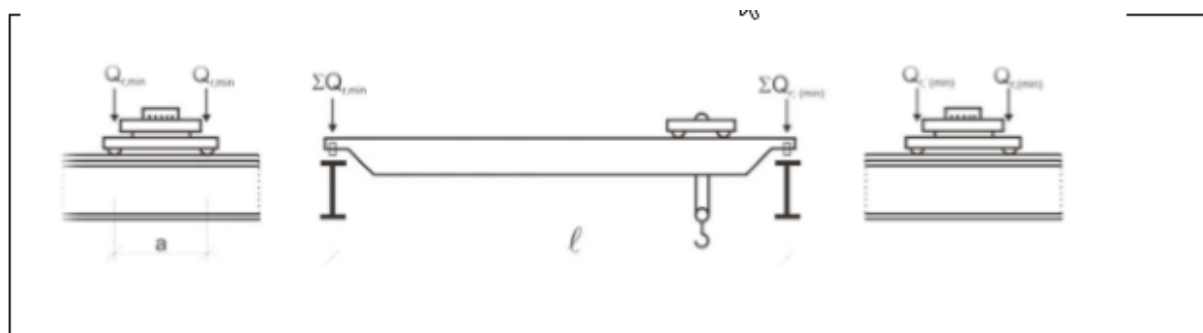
Disposition de charge de l'appareil de levage à vide pour obtenir un chargement minimal sur la poutre de roulement.
